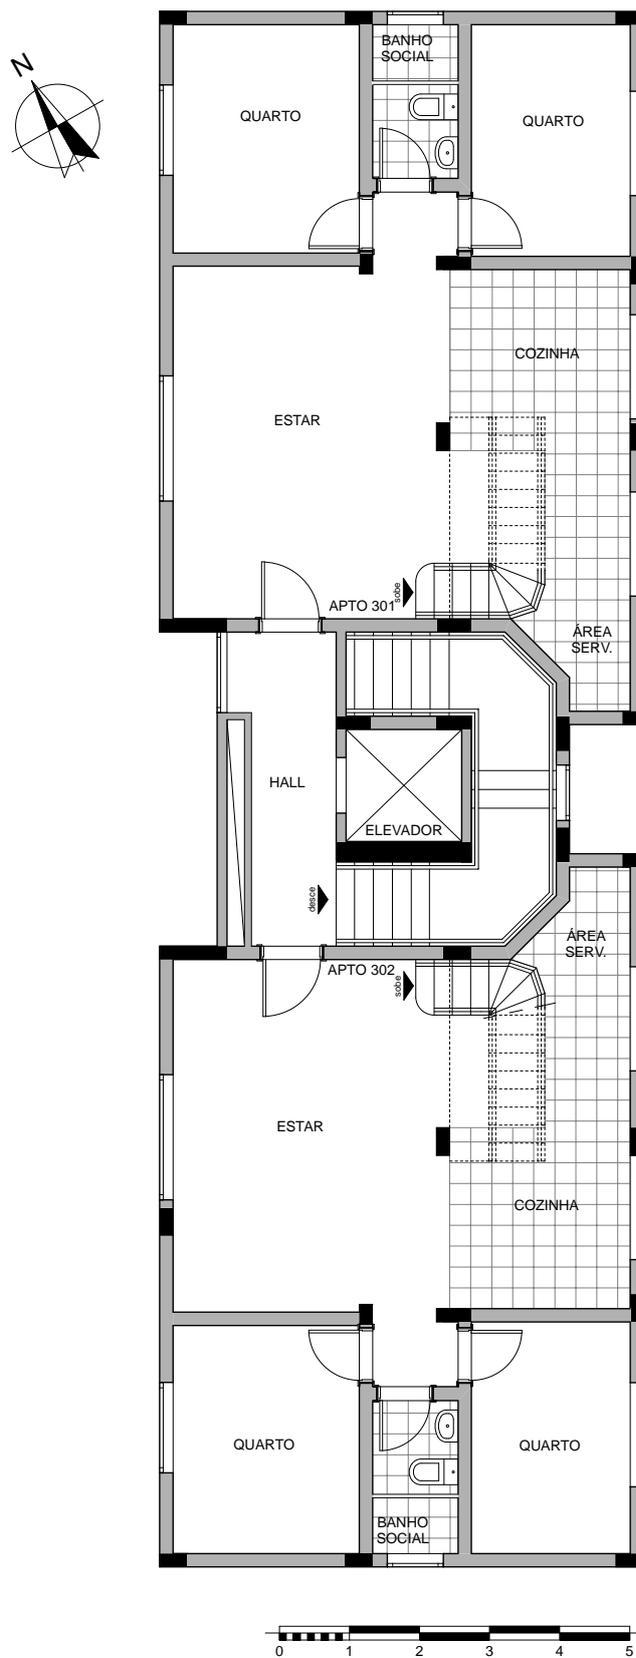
Planta 3º pavimento - cobertura (Fonte: Autora, 2016)
